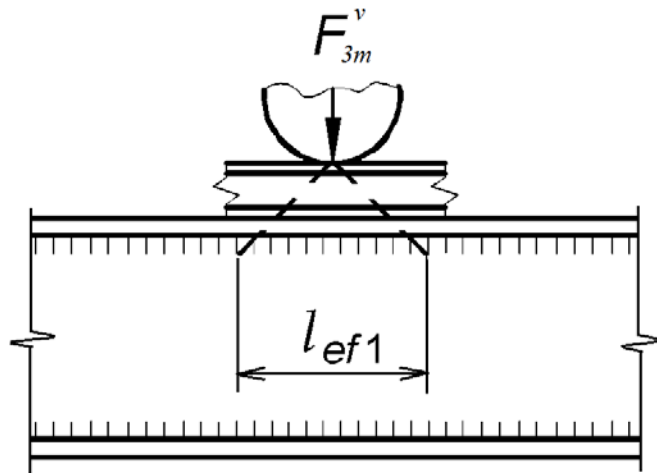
Схема передачі зосередженого навантаження на стінку головної балки.
